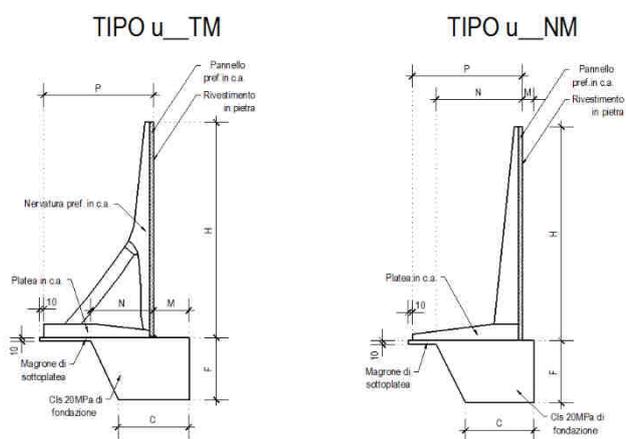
Muri prefabbricati sezioni tipologiche - Sottovia kim. 11+500
